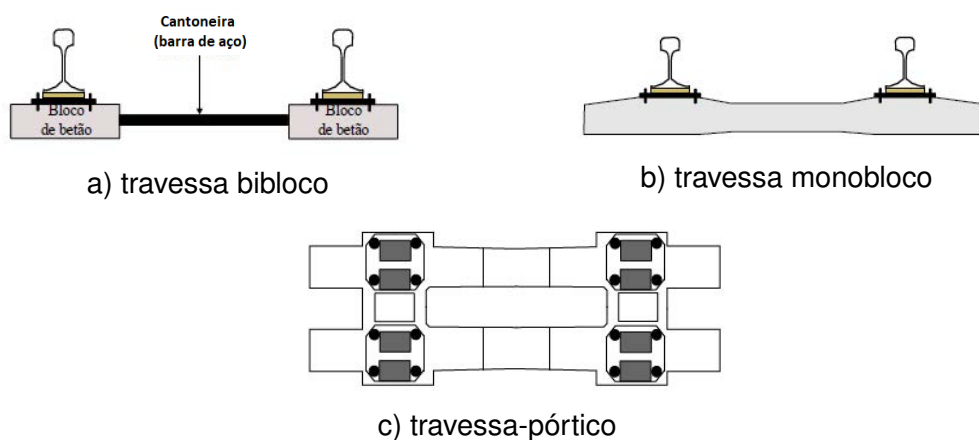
Tipo de travessas de betão (Vale, 2010)
